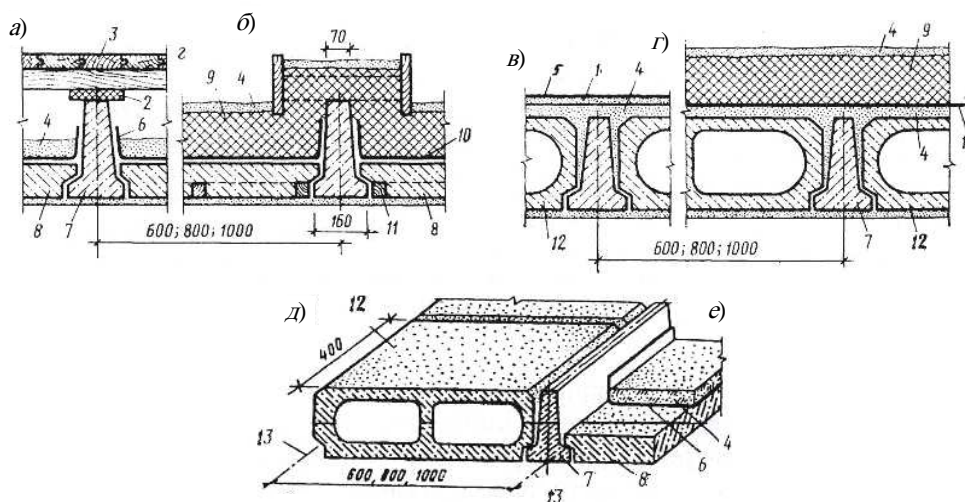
Перекрытия сборные по железобетонным балкам:
